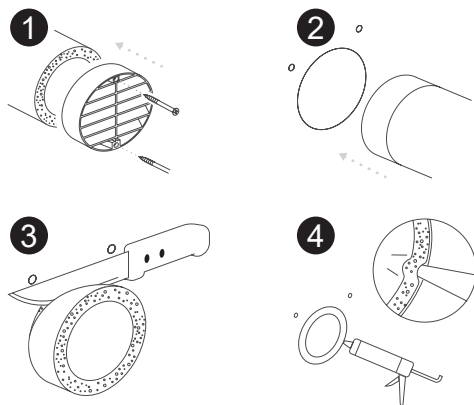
Установка теплоизоляционной трубы с вентиляционной решеткой в канал
